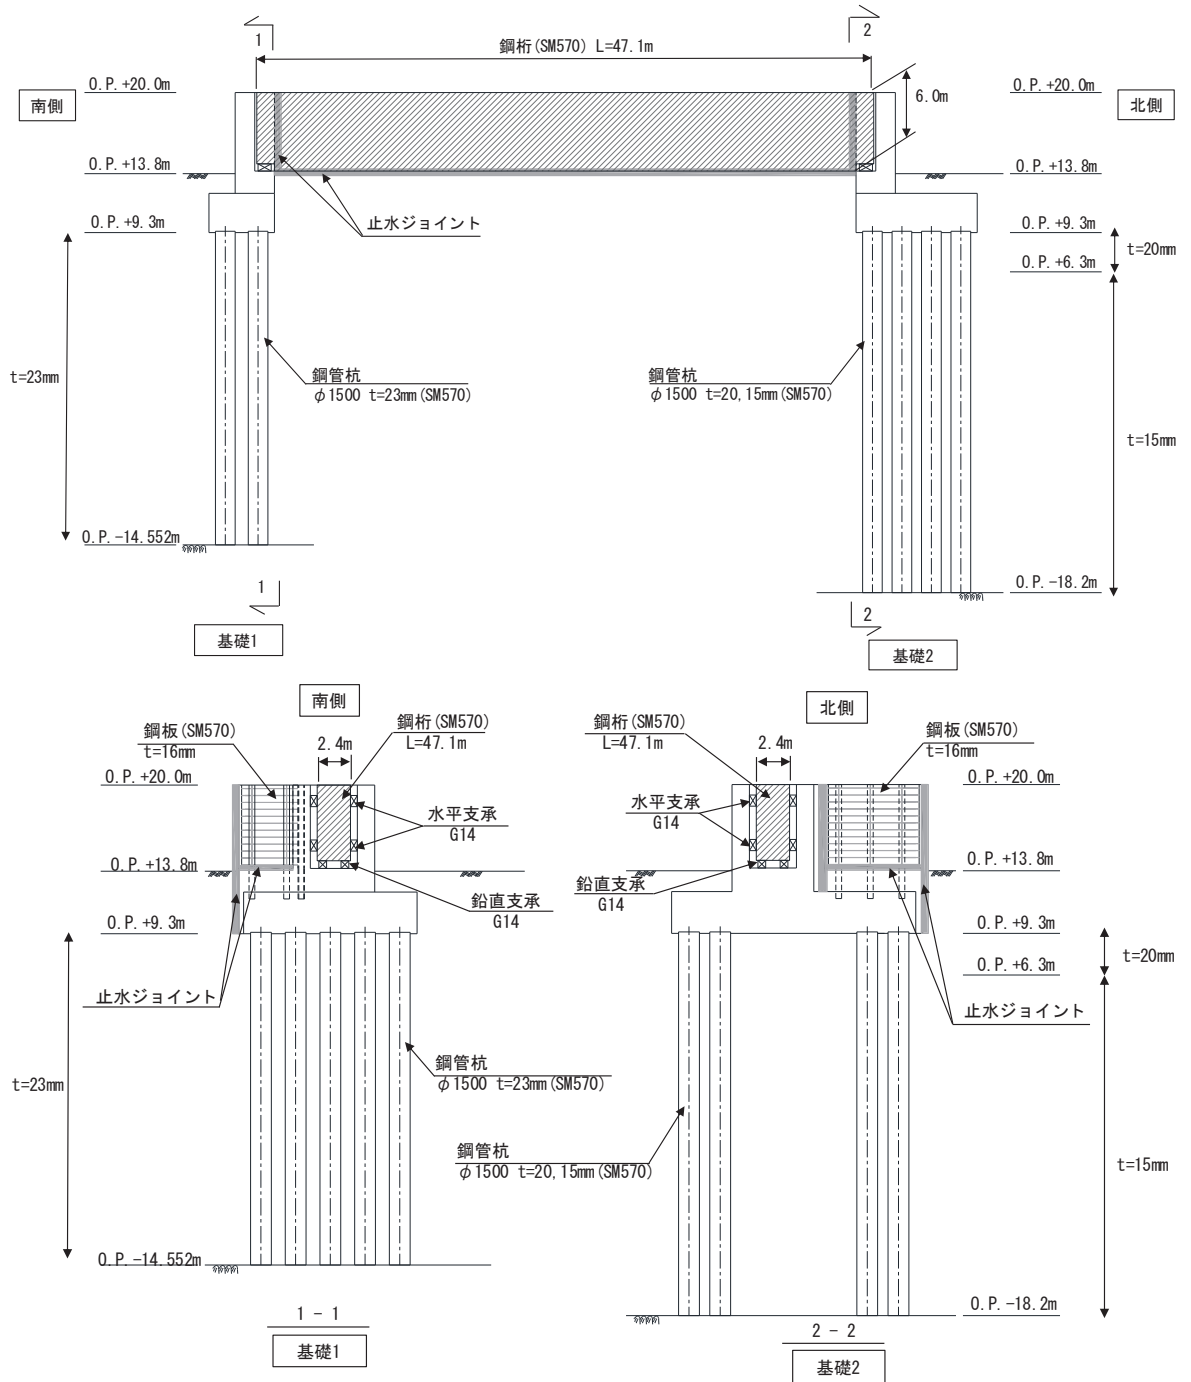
鋼製遮水壁 (鋼桁 4) 正面図及び断面図
